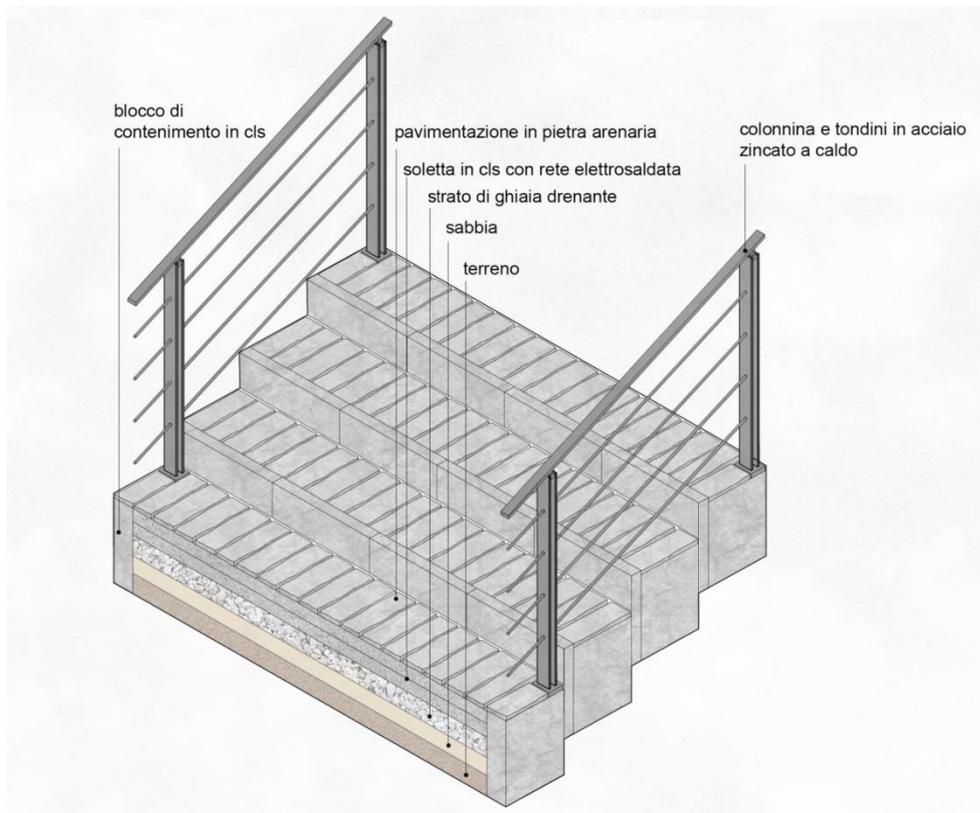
Dettaglio scala in blocchi di pietra arenaria.
